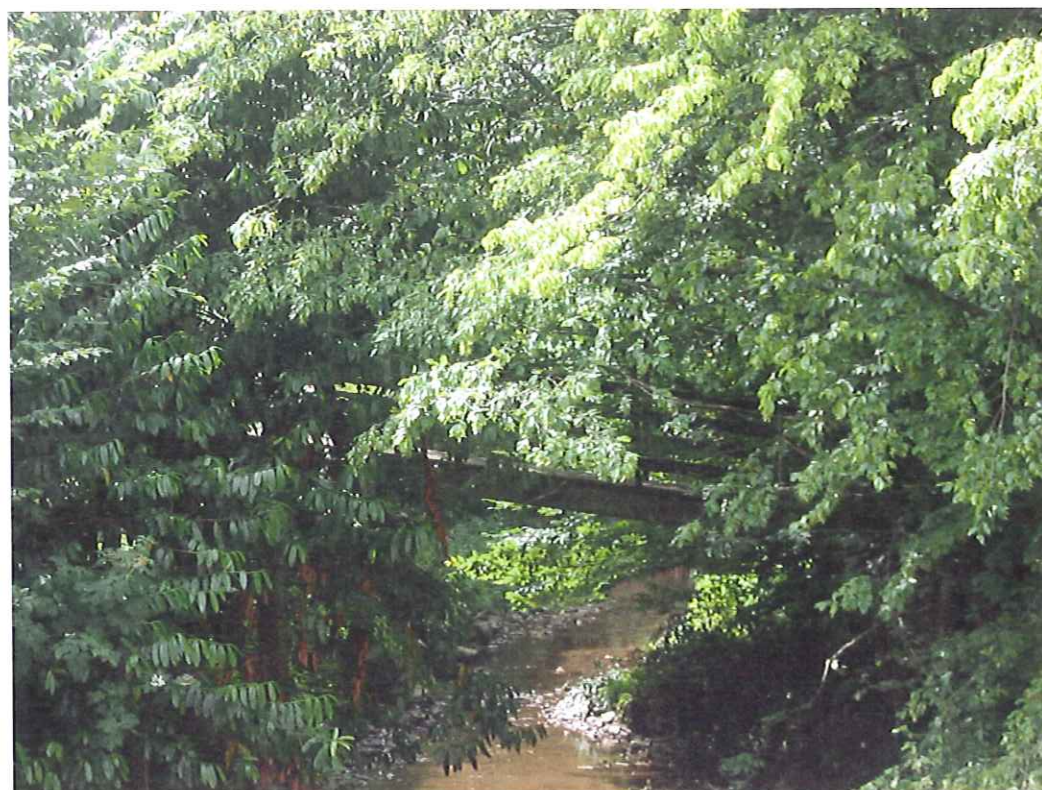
Ouvrage ERN20 (passerelle de la Claie)
